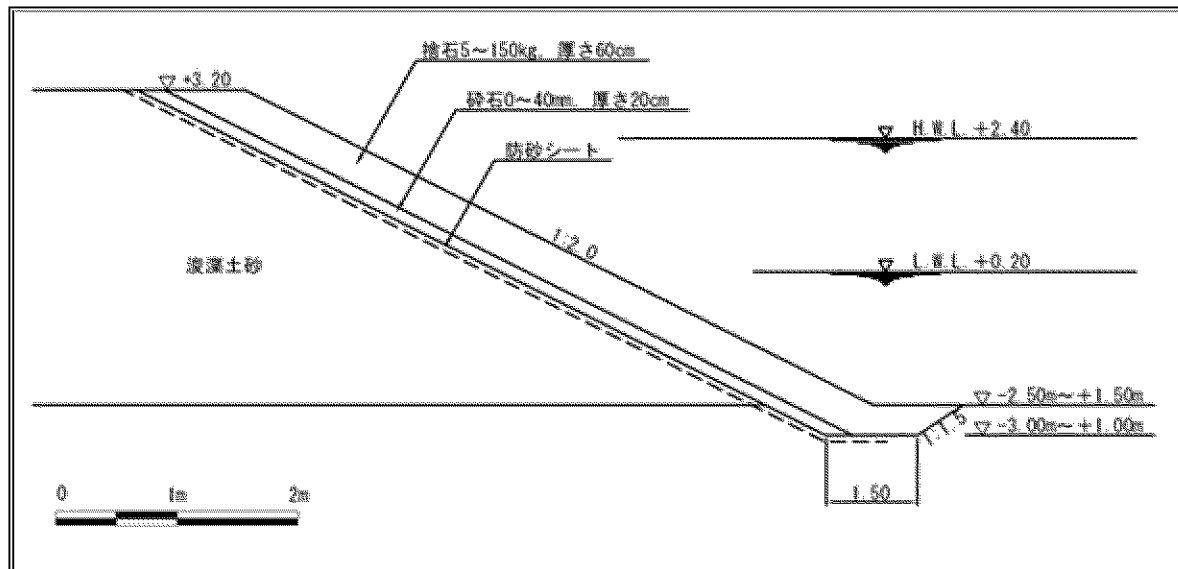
(6-2) 護岸標準断面図 (護岸 B : 埠頭西側端部)
